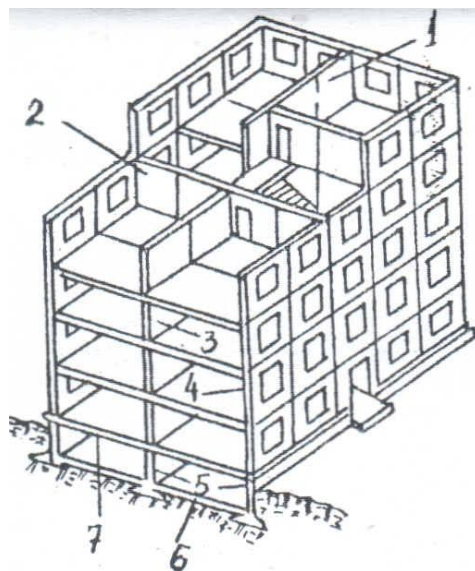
Схема бескаркасного крупнопанельного здания:
